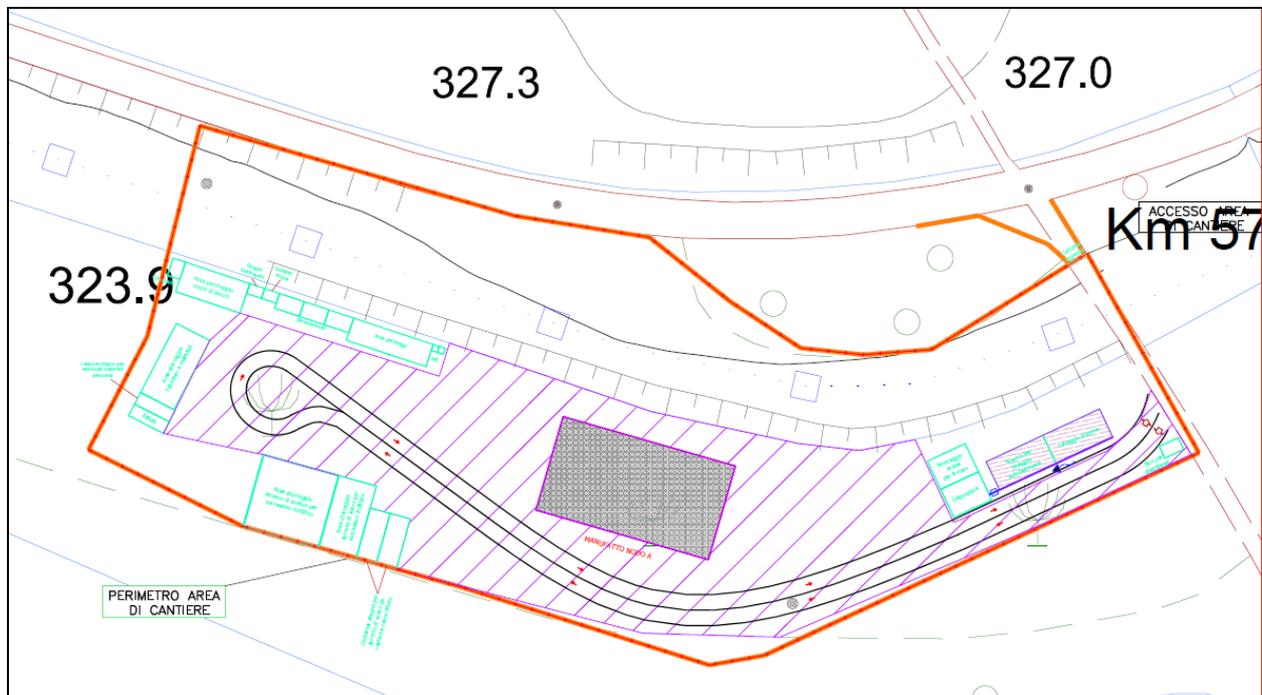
Stralcio planimetrico area di cantiere Manufatto Nodo A
